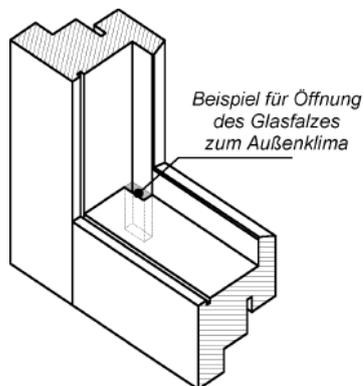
Dampfdruckausgleich nach außen über Öffnungen
